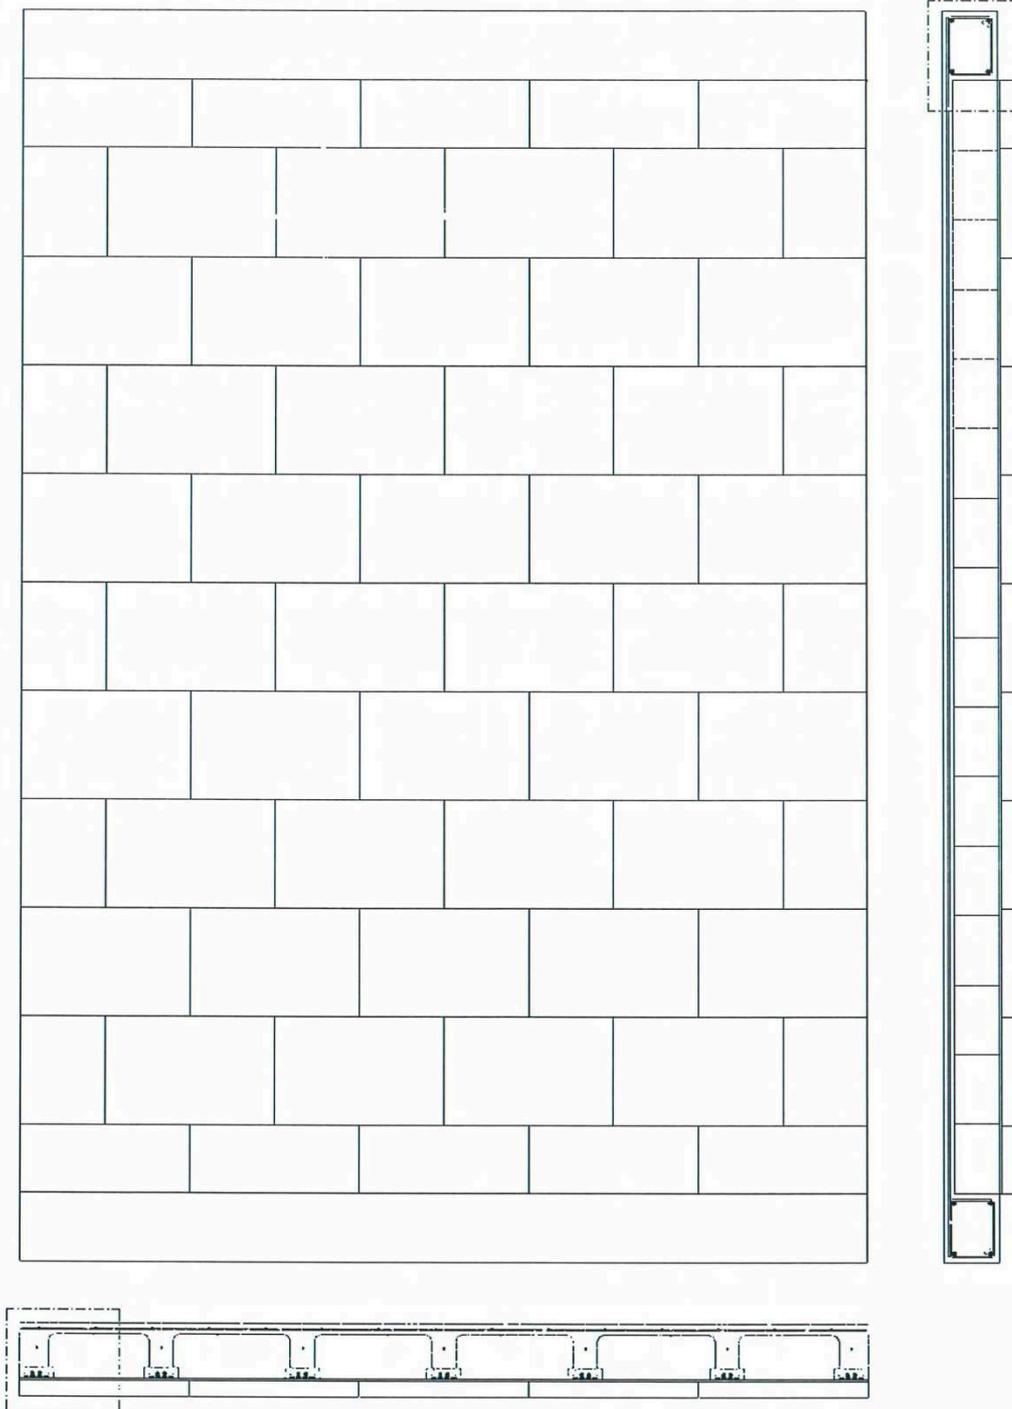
Estratto da rapporto di prova N. 323473/3715FR su solaio in latero cemento – vista in pianta.
